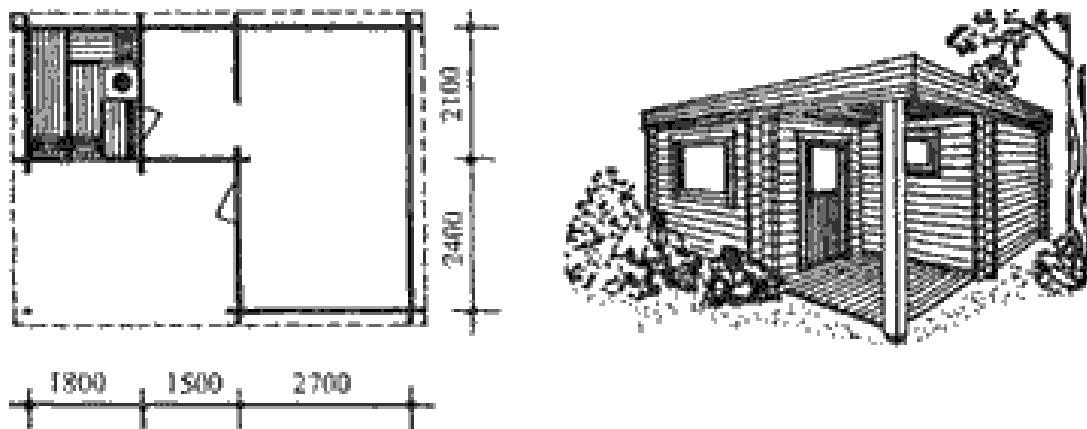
Фасад и план сауны на 3 человека с предбанником и комнатой отдыха.
